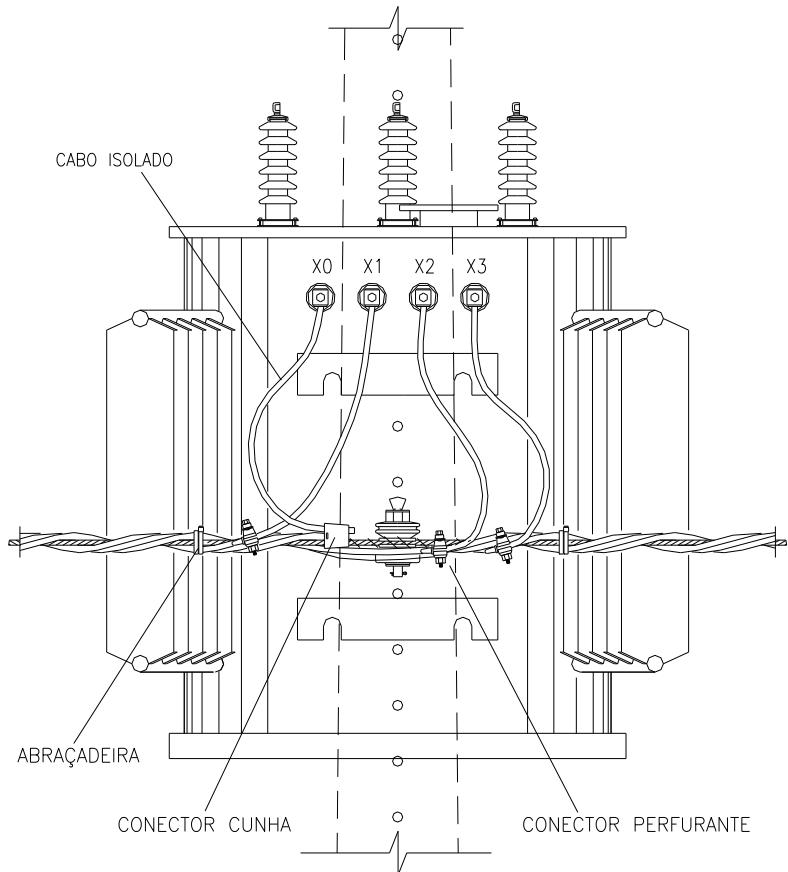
Amarrações e ligações – Secundário – ligação de baixa tensão do transformador
